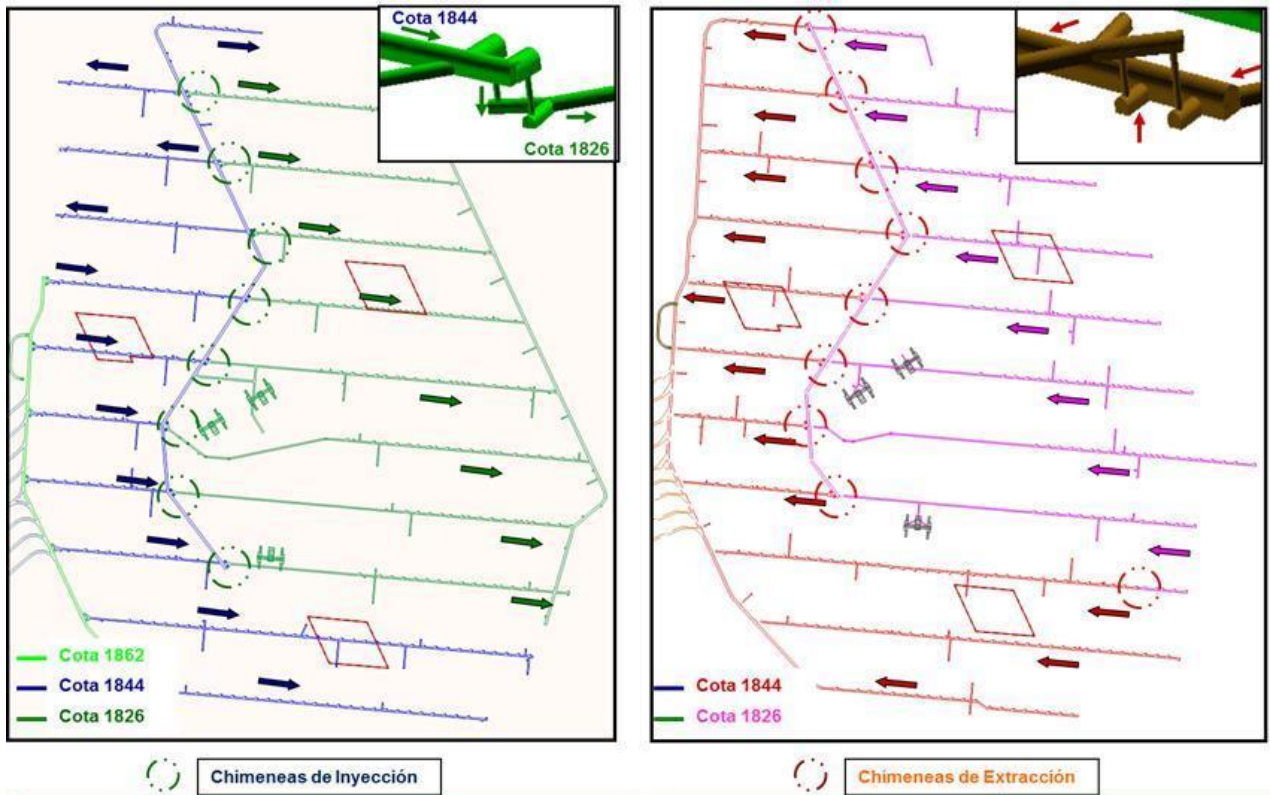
Layout Sub Nivel Ventilación (Inyección y Extracción)
